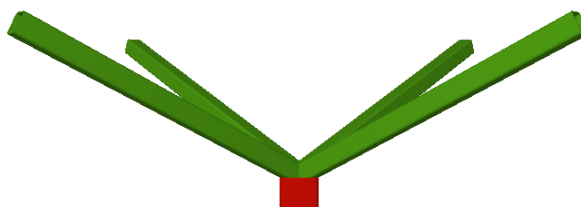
Vistas de las torres de apoyo 1 y 2
